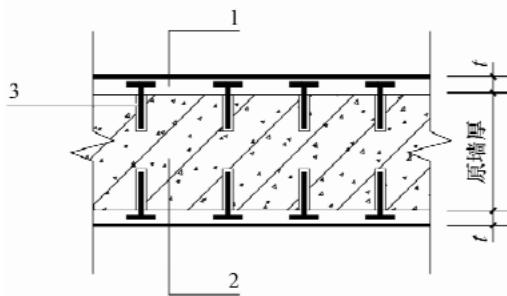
高延性混凝土面层加固钢筋混凝土剪力墙构造
